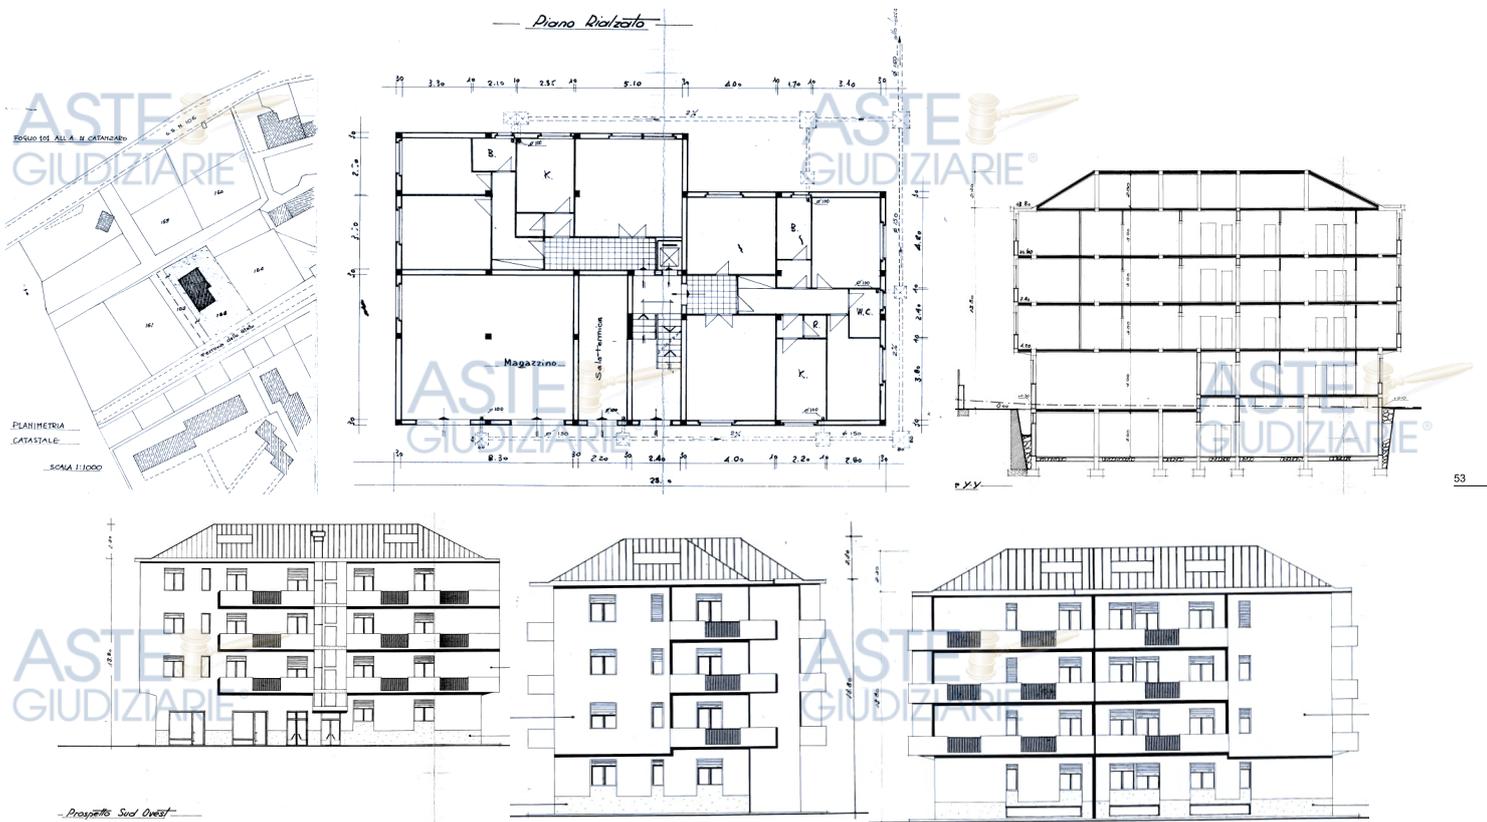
Stralcio elaborato progettuale Concessione Edilizia n.2139/1980 del 18/11/1980 – Pianta, prospetti e sezioni
